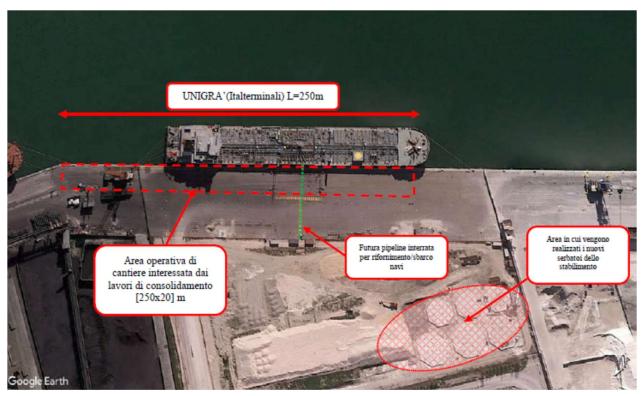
Banchina Trattaroli Nord – area di cantiere prevista nel PD
